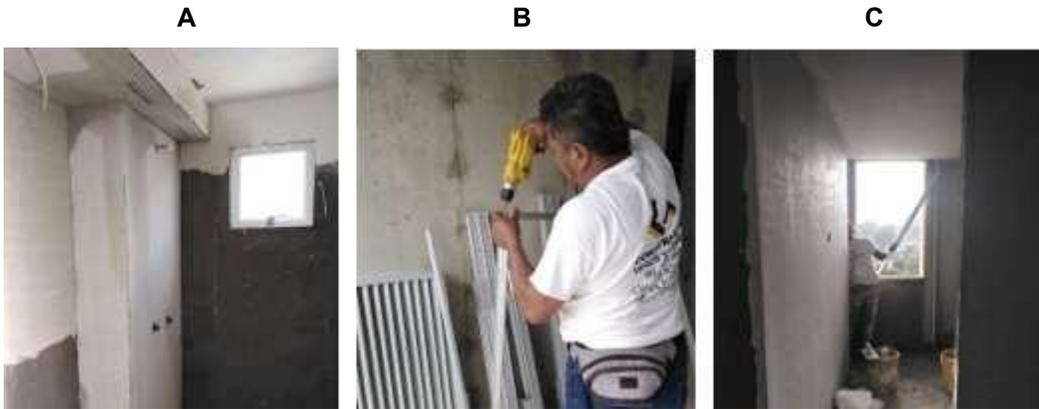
41A. Estructura Board., 41B. Ventanería, 41C. Nivel de Muros.
